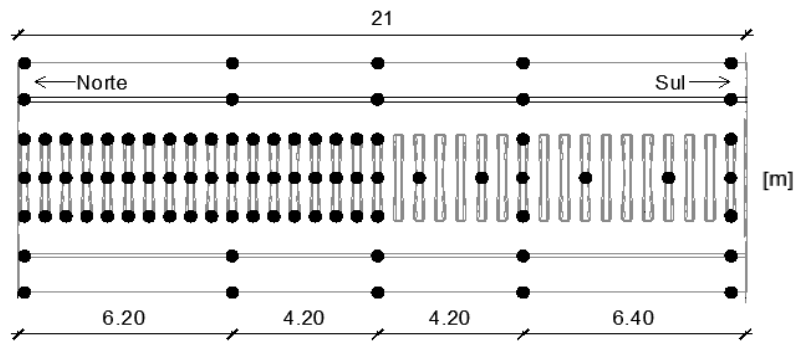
Localização em planta dos pontos a monitorizar no tramo de 21,0m
